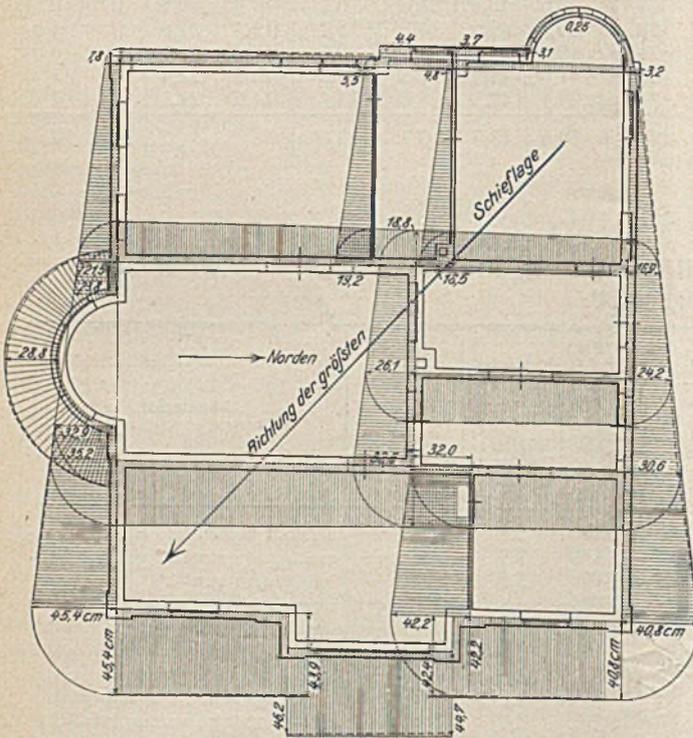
Senkungsplan des Erdgeschoß-Fußbodens.
